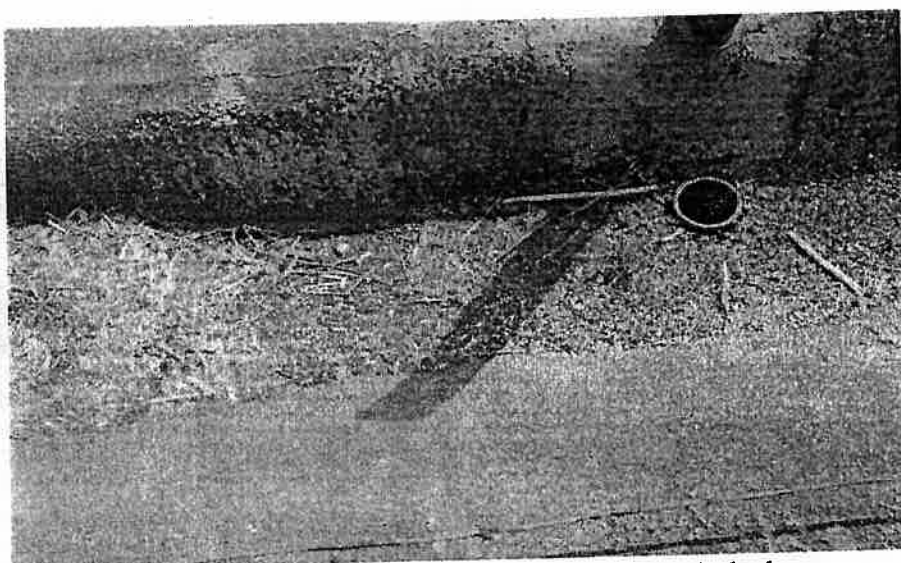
Brak czyszczenia koryt spływowych dachu.
